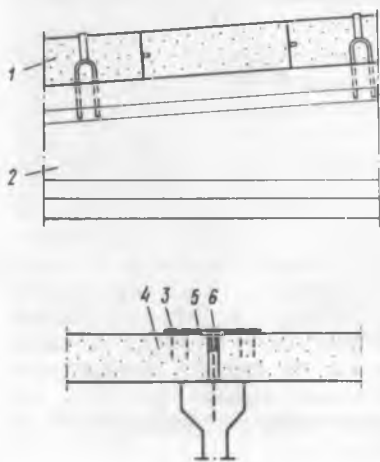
Крепление ячеистобетонного элемента покрытия, при котором оцинкованные скобы заделаны в железобетонную балку
